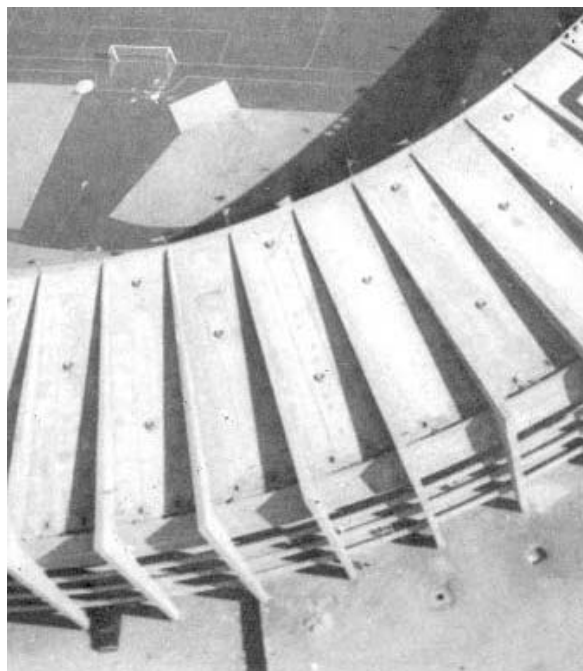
Vista aérea de detalhe da estrutura da cobertura do Mineirão, antes da execução da impermeabilização
